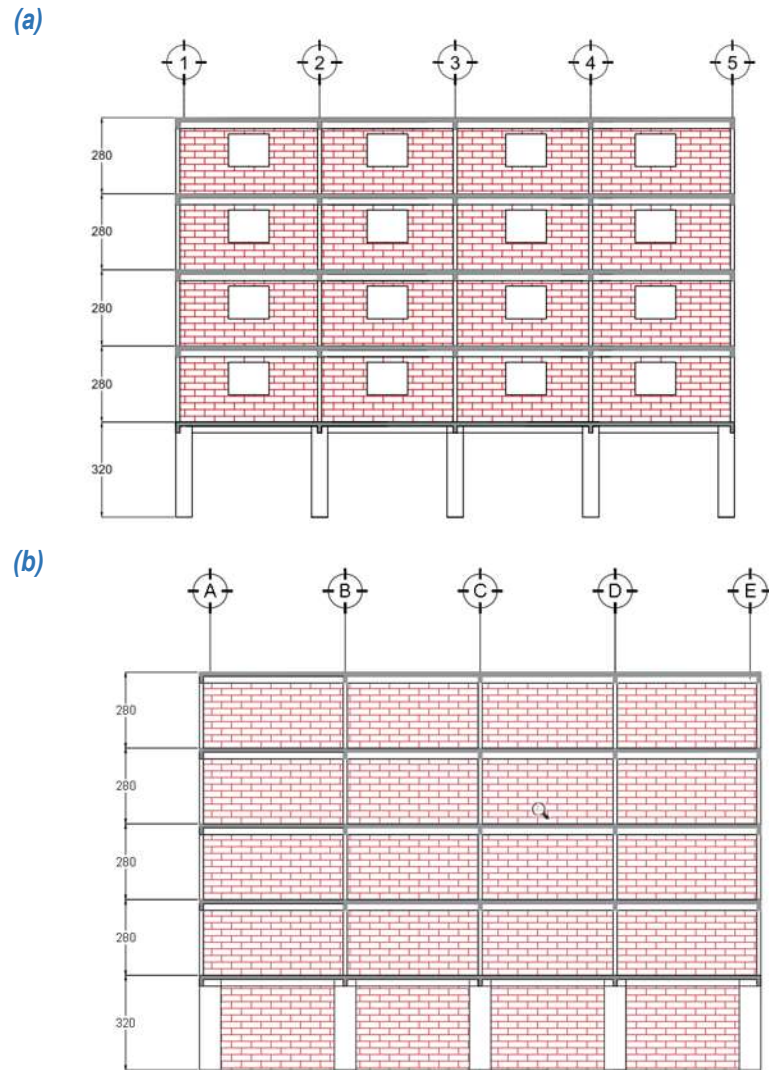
Estructuración en alzado propuesta en modelo 4: (a) fachadas frontal y posterior, y (b) fachadas laterales (Acotaciones en centímetros).
